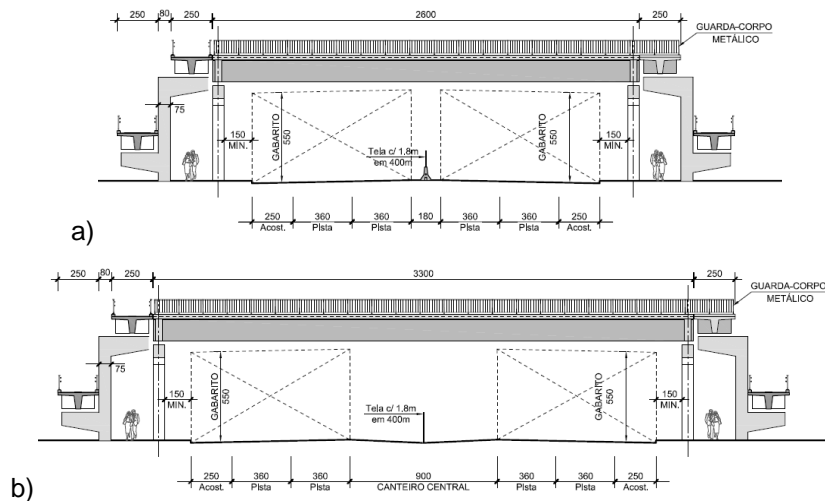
Passarelas. Elevação: a) com barreira rígida; b) com canteiro central.
